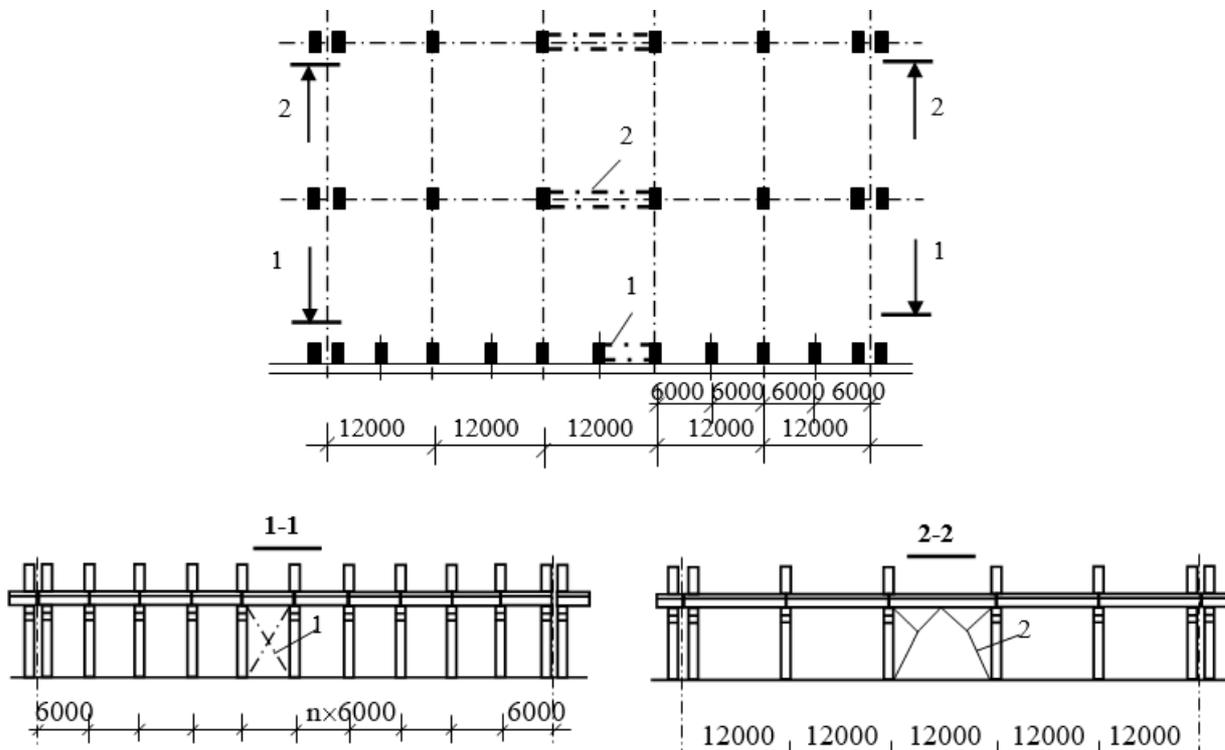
Каркас ОПЗ с применением подстропильной фермы
